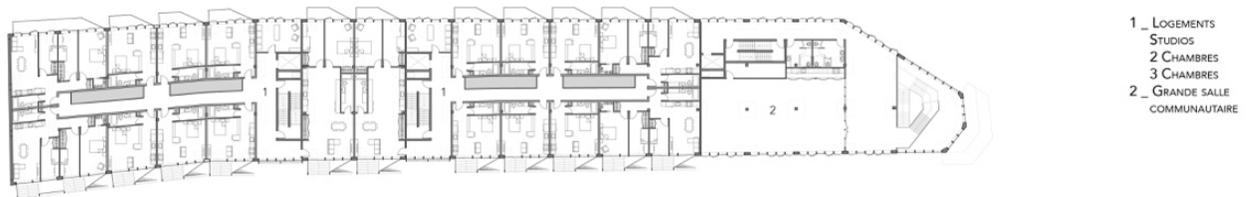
\_ Plan du 6<sup>e</sup> Étage
